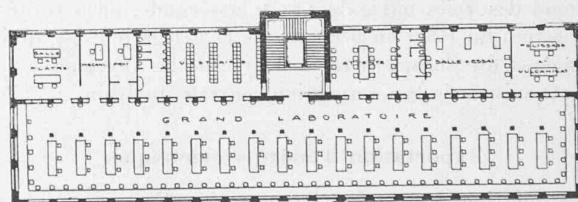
Plan du 2^e étage. — 1 : 800.
